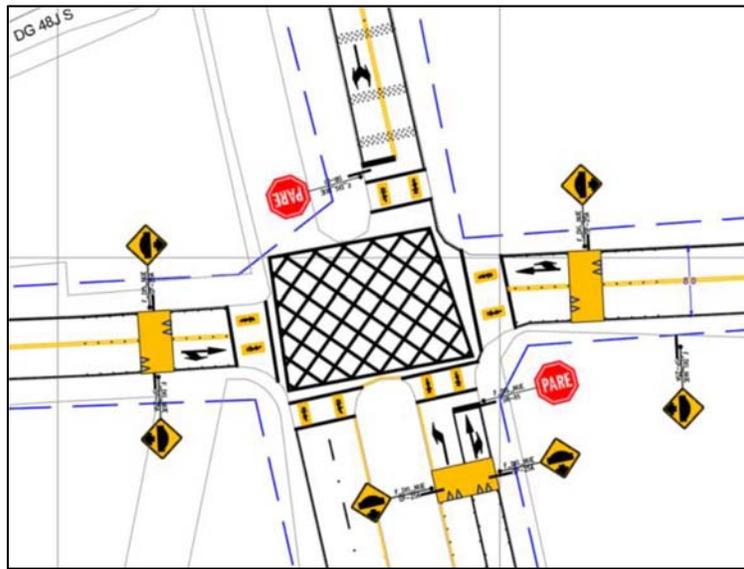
Dispositivo de control de tráfico para la Transversal 5J por Diagonal 48 Sur.
